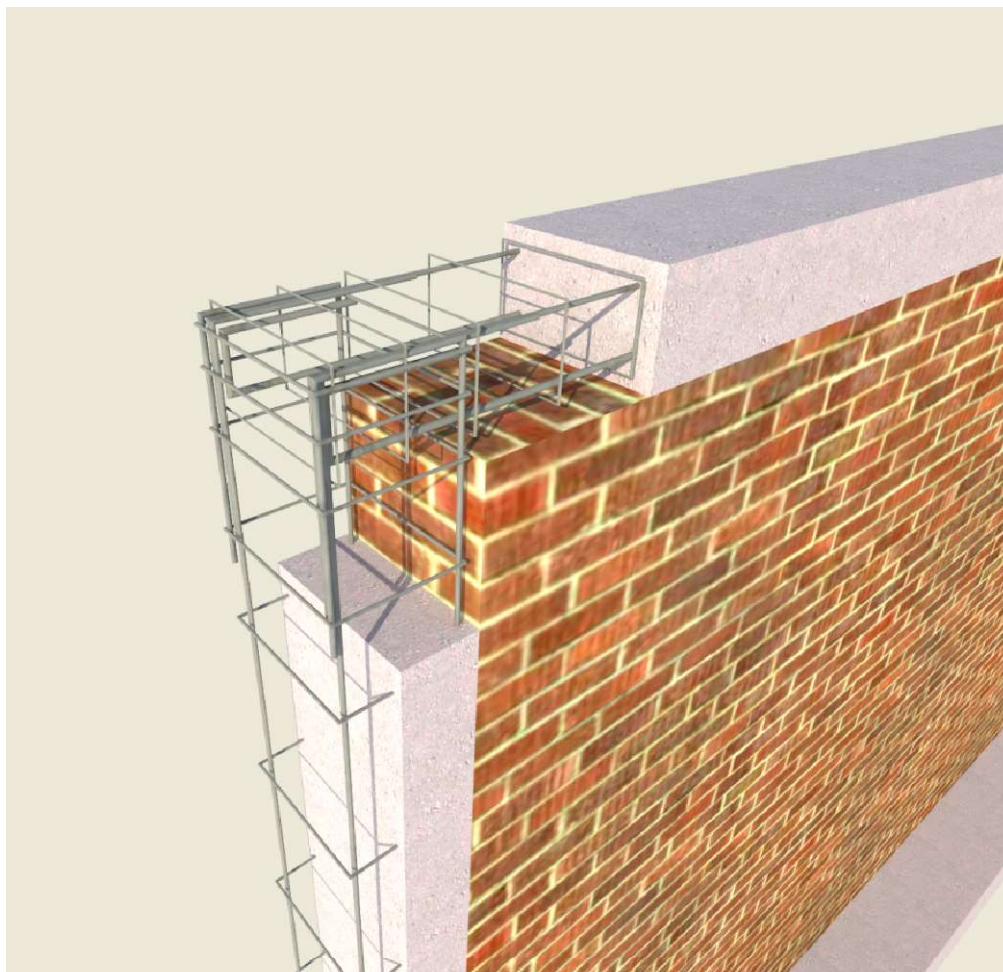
Detalle nudo enadenado vertical y encadenado horizontal superior
